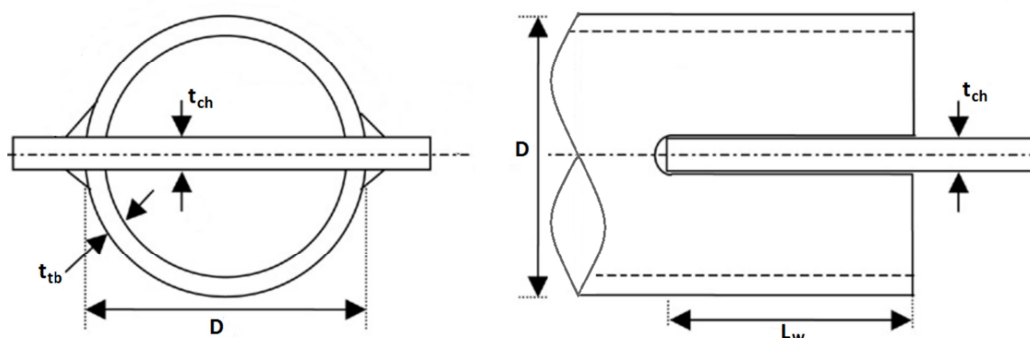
Rasgo no tubo. a): vista frontal; b): vista lateral (Fonte: adaptado de *Ling et al., 2007*)
